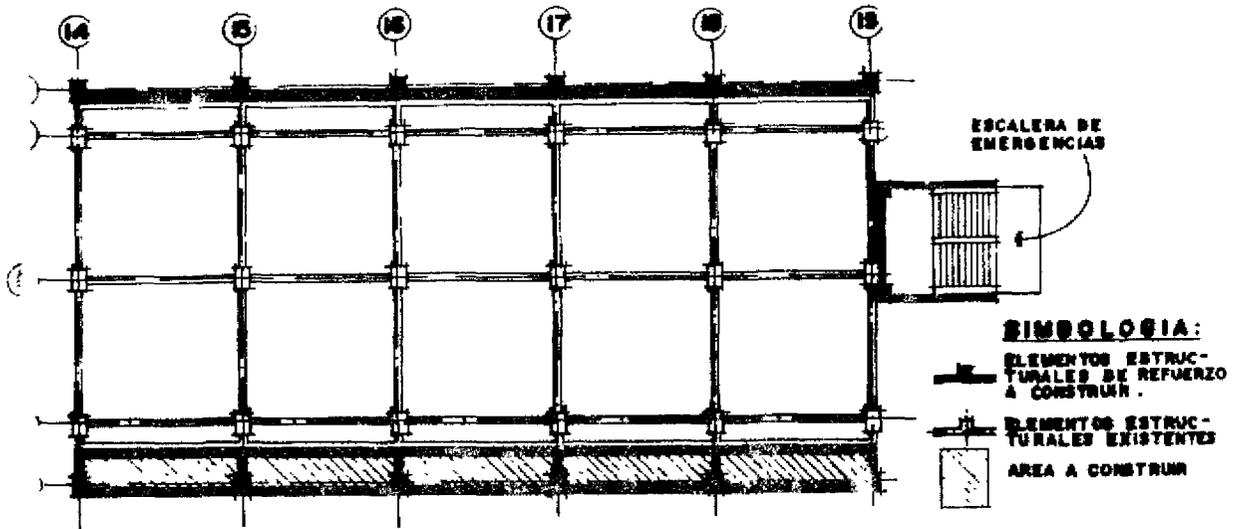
PLANTA ESTRUCTURAL TIPICA EDIFICIO NOR-OESTE Y ESCALERA DE EMERGENCIAS
